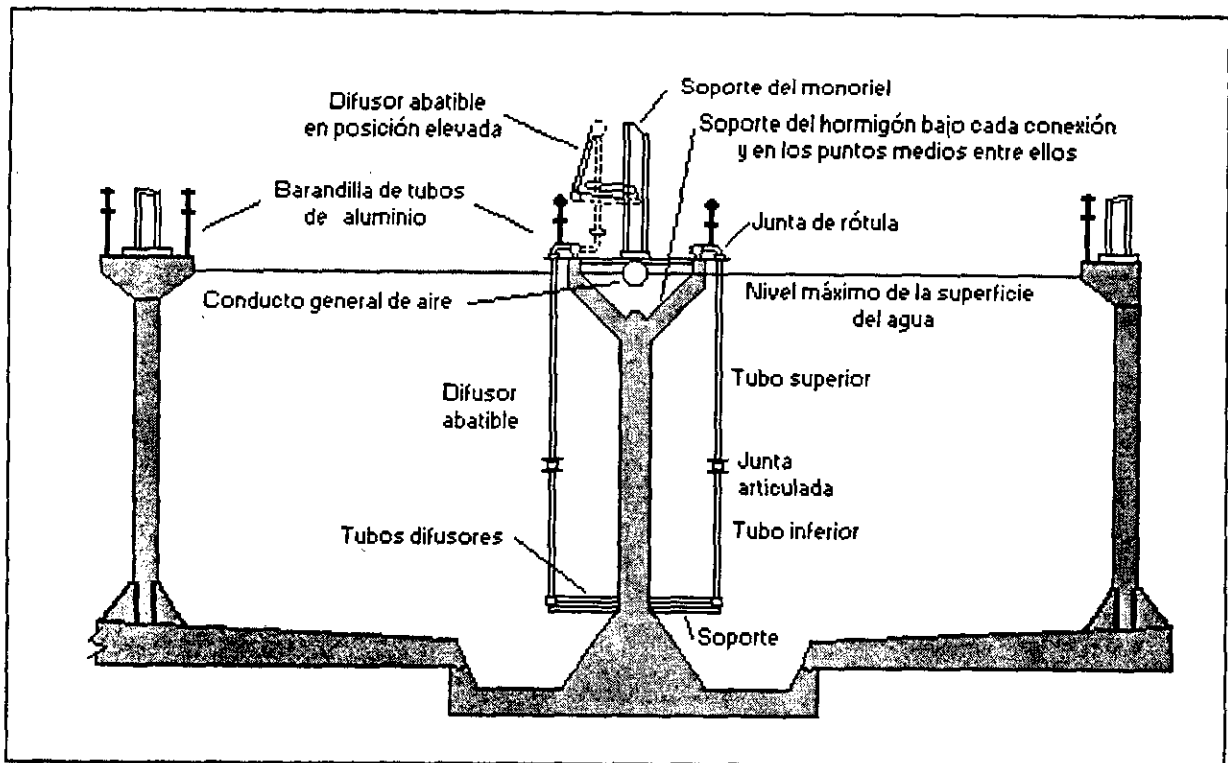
Sección transversal típica de un desarenador aireado (Metcalf & Eddy, *op. cit.*).
